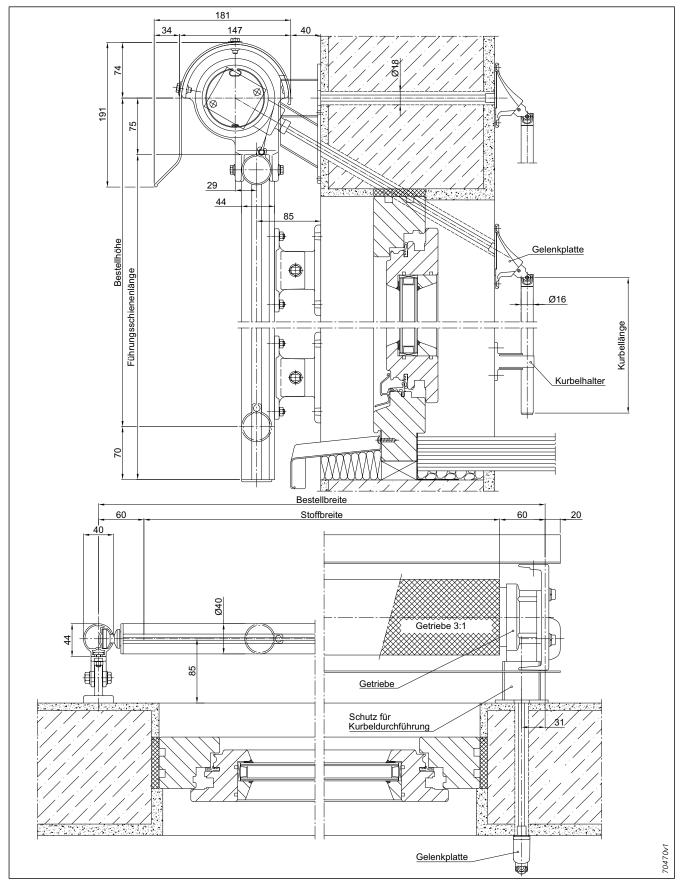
Fassaden-Markise 201 mit Halbrundblende Typ 2.3; Kurbelantrieb
